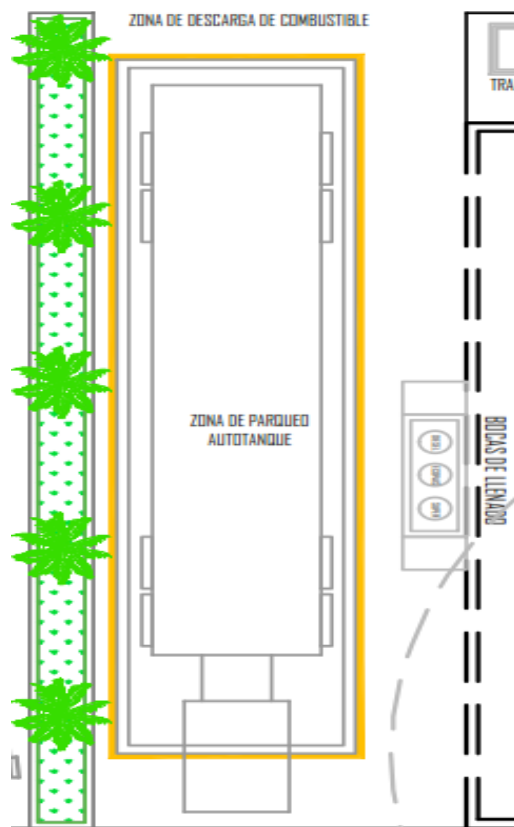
Área de descarga. Fuente: Plano arquitectónico
